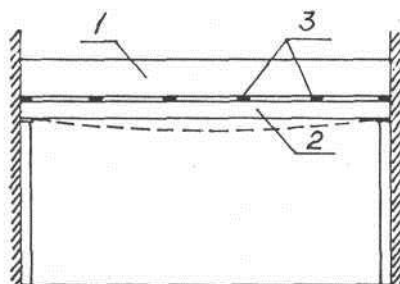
(1 — усиливаемая балка, 2 — усиливающая балка, 3 — прокладки)
